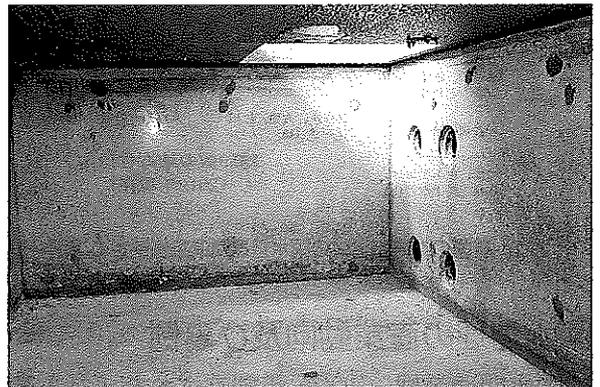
基礎を兼用したコンクリート製の地下貯留タンク
